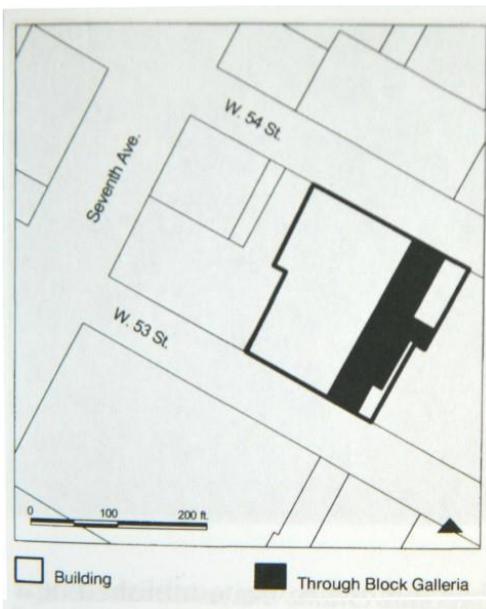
Planta (KAYDEN et al. 2000, p. 163).
